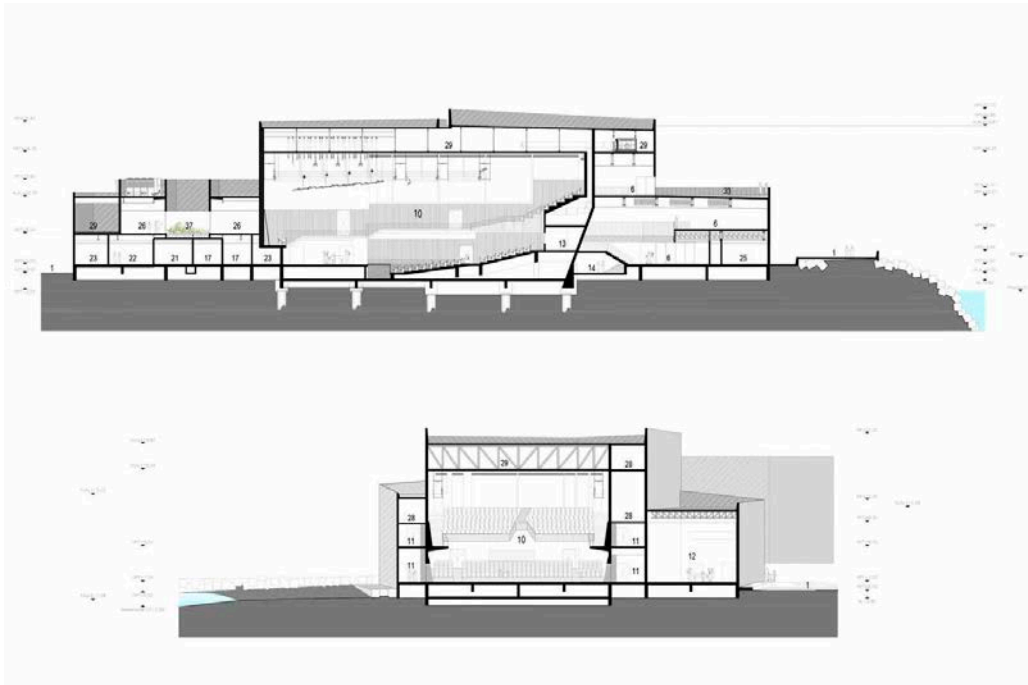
"Planimetrías, Cortes en Sección del proyecto, Sala de Conciertos."
